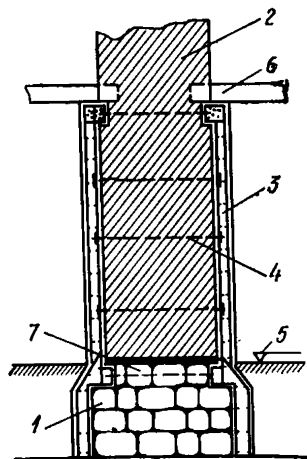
Усиление внутренних стен подвала и фундамента железобетонными обоймами
